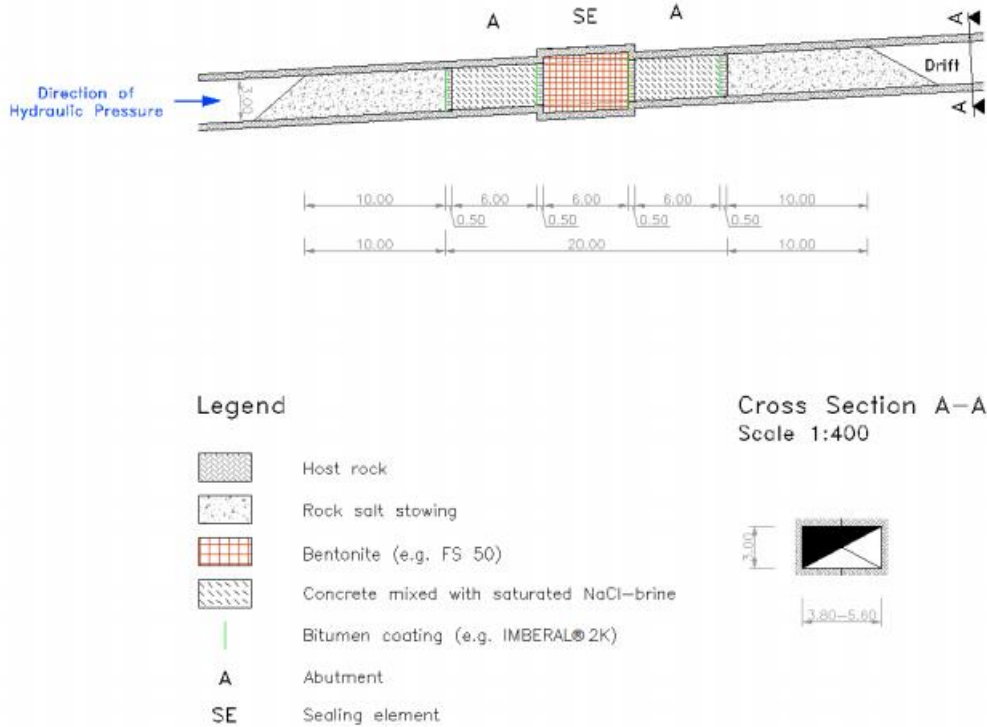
Schéma de construction d'un barrage en bentonite [12].
